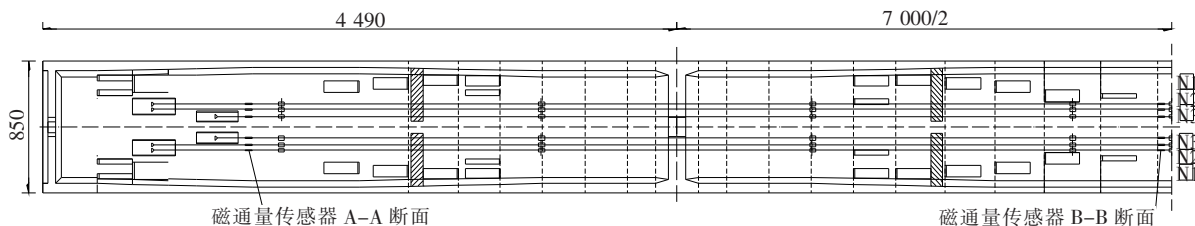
体外索及磁通量传感器布置平面图(单位:cm)
